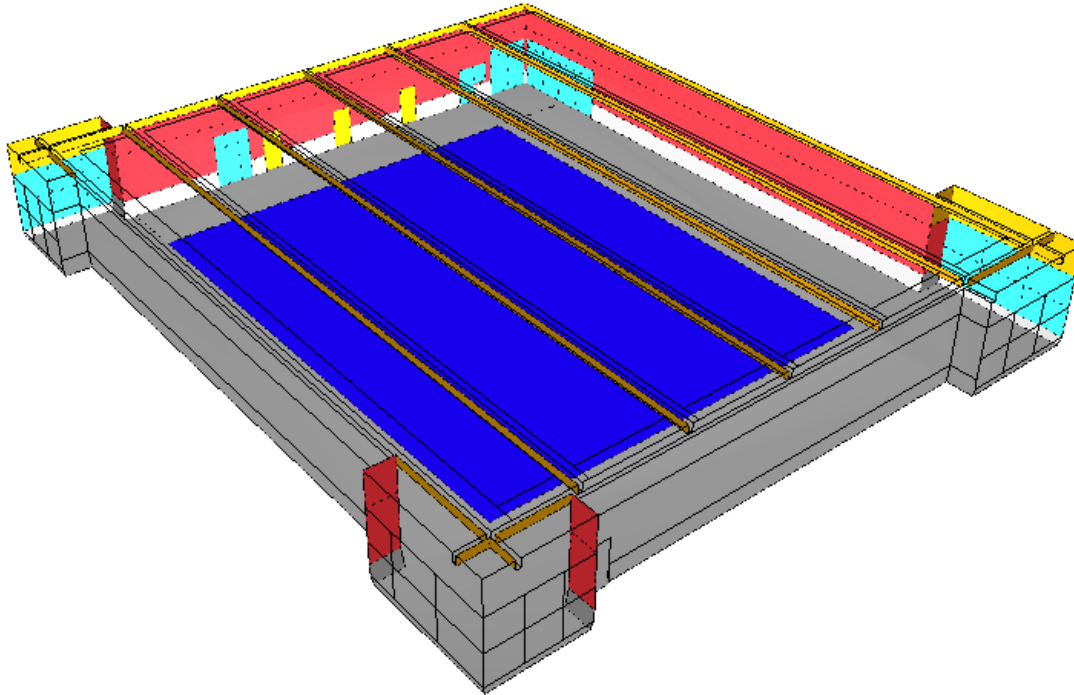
25 m bassäng - vy 1 - spaltpanel upp till 3,4 m
